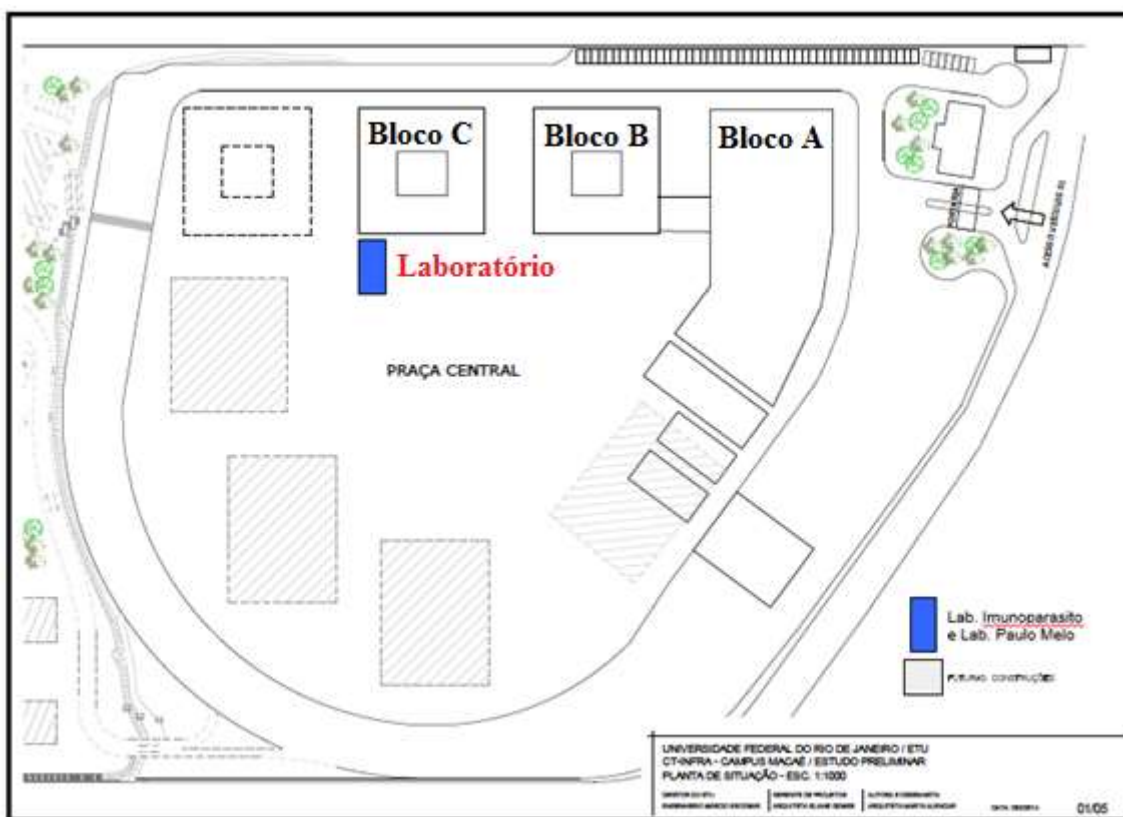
Planta de situação do Campus, Arquivo da UFRJ.
